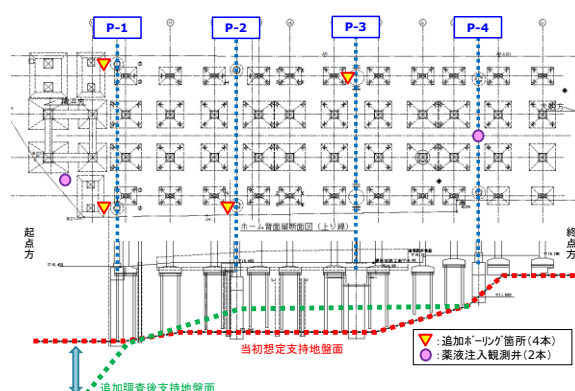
追加ボーリング・観測井実施箇所（平面図・断面図）
